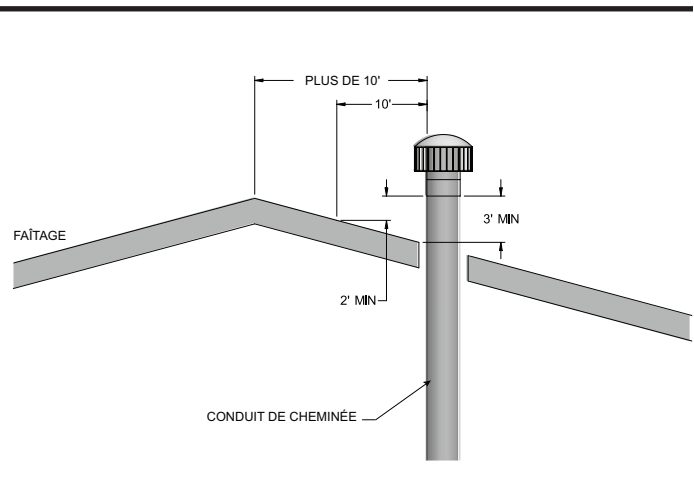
Terminaison de ventilation depuis un toit à double pente - 10 pi. ou plus du faîtage
